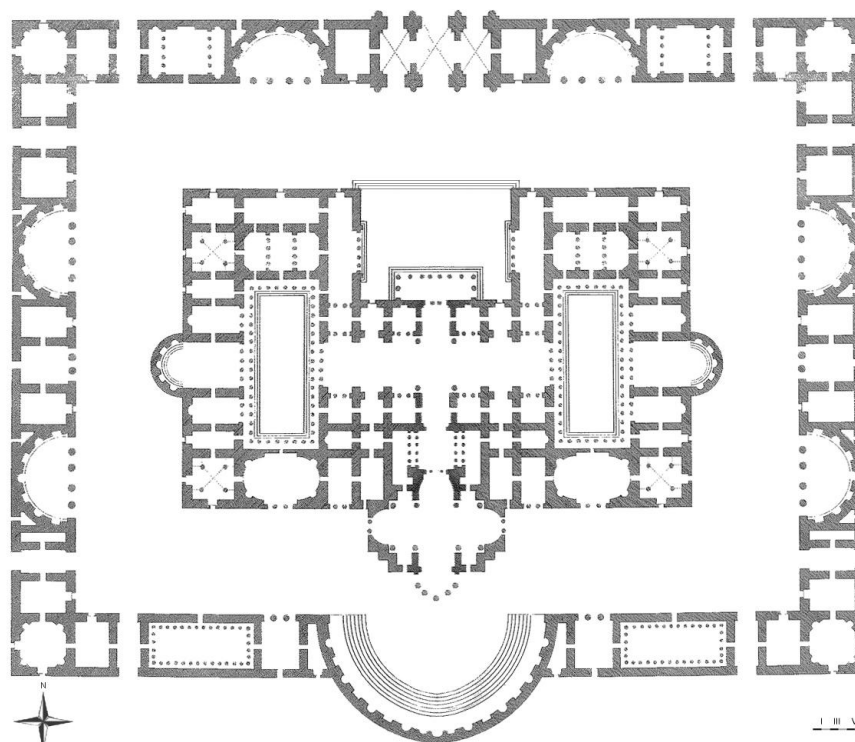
Planta termal segundo de Leon Battista Alberti,
